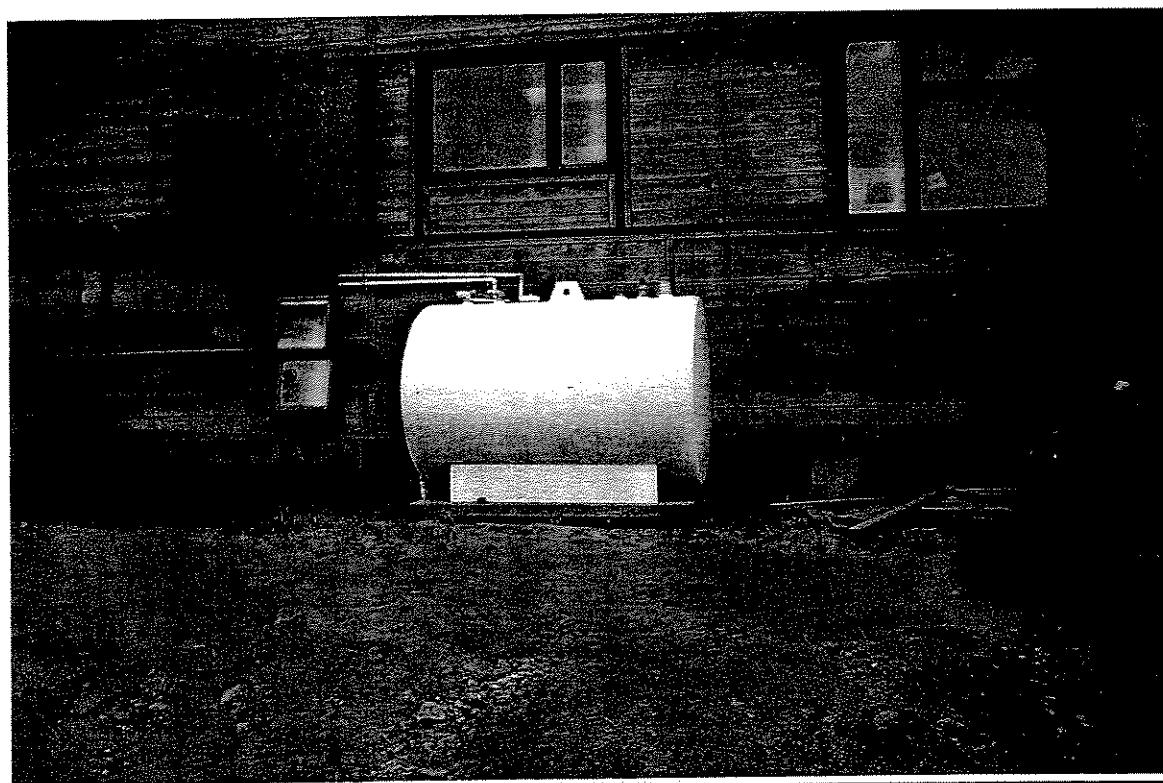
Réservoir de mazout 2 273 litres en face de la garderie.
